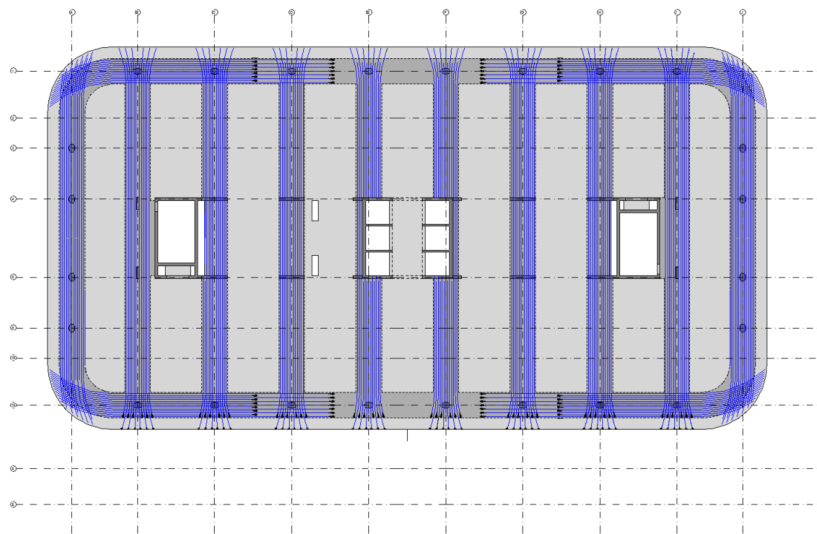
Cabos de pré-esforço em laje do piso tipo
